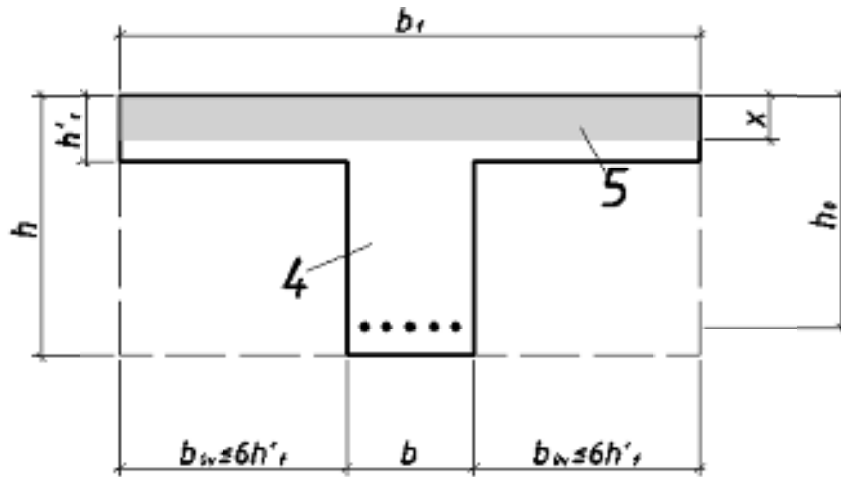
Тавровое сечение с одиночной арматурой.
